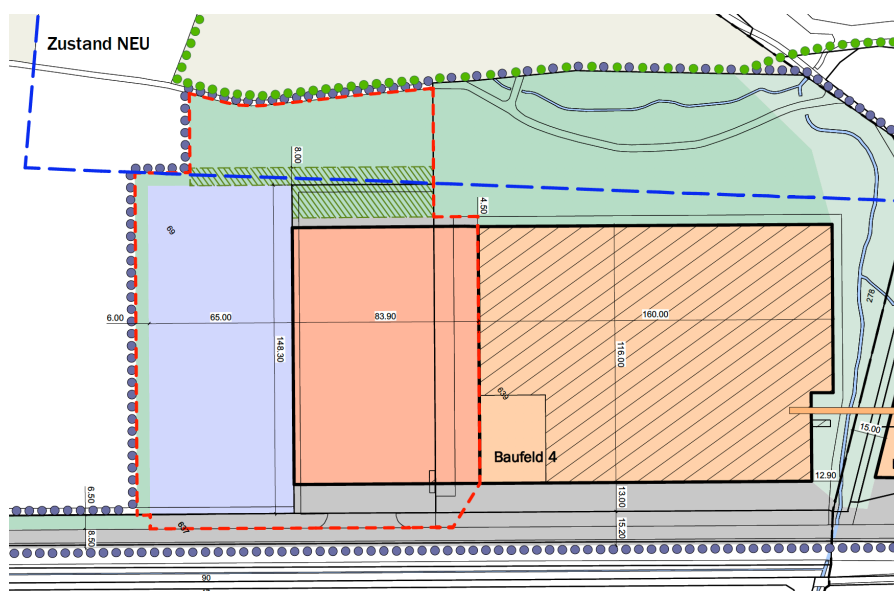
Überbauungsplan neu mit Änderungsperimeter (rot gestrichelte Linie)
